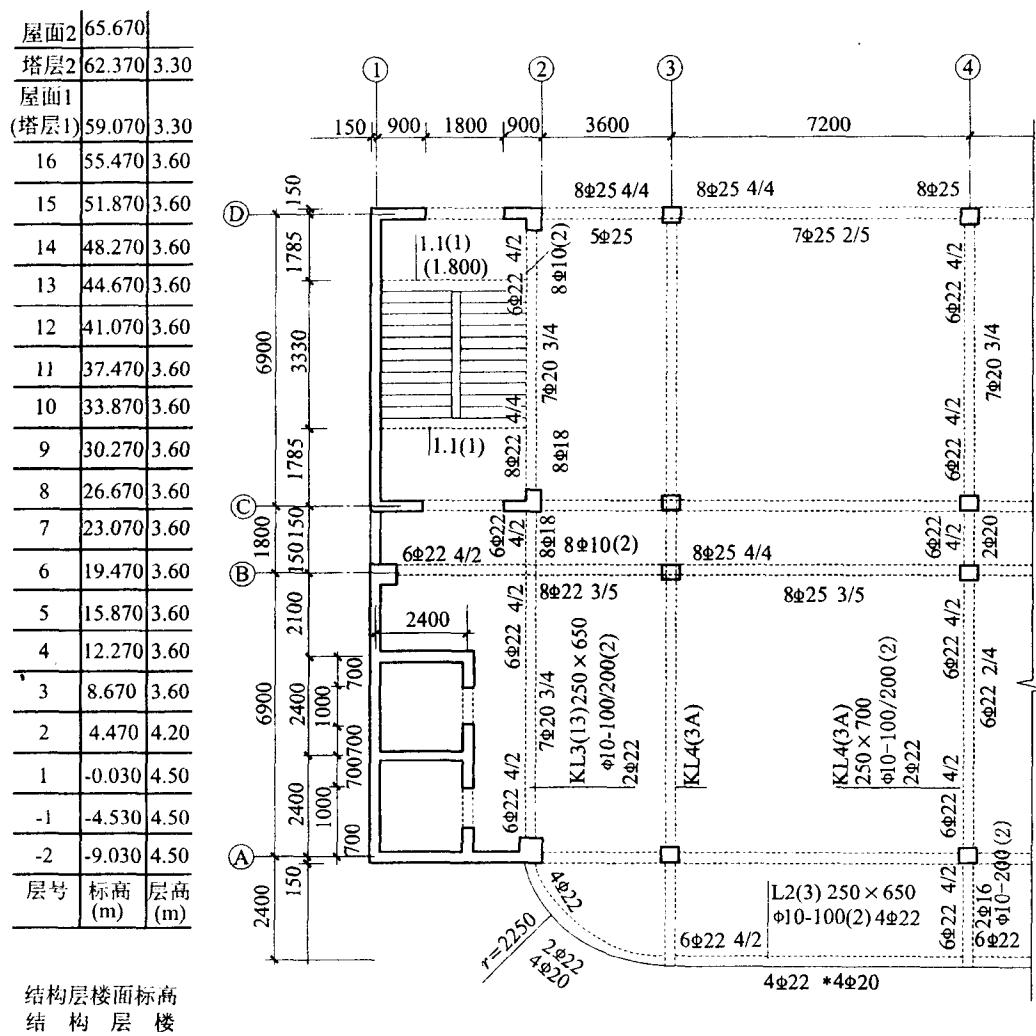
15.870—26.670 梁平法施工图平面注写方式
